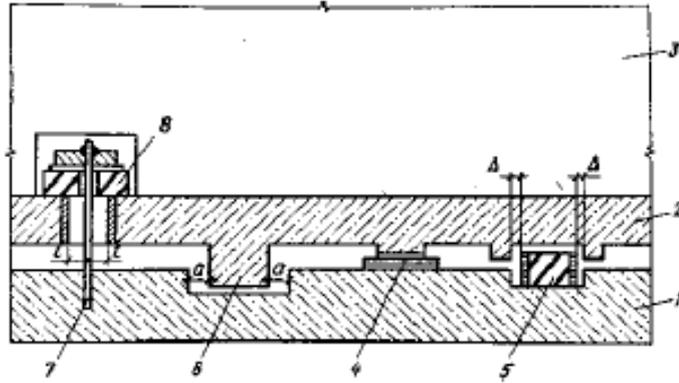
Схема элементов сейсмоизолирующего скользящего пояса: 1 - верхняя обвязка фундаментов (стен подвала или технического подполья); 2 - ростверк; 3 - надземные конструкции здания; 4 - скользящая опора; 5 - упругий ограничитель горизонтальных перемещений (демпфер); 6 — жесткий ограничитель горизонтальных перемещений (упор); 7 – ограничитель вертикальных перемещений (вертикальная связь); 8 — вертикальный амортизатор
